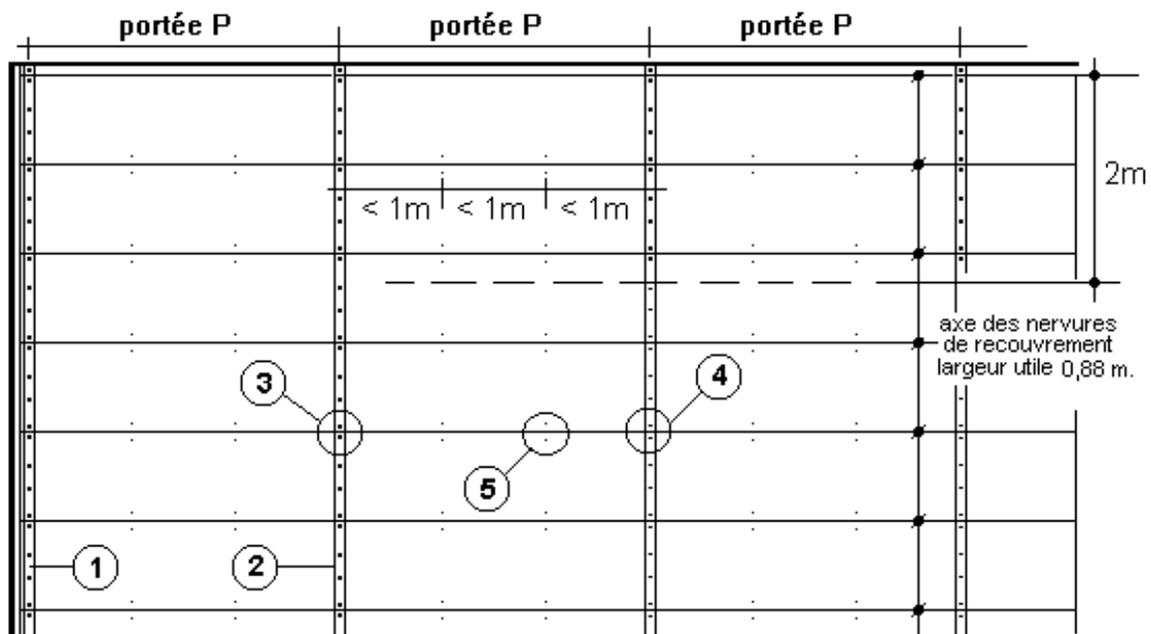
Fixations du bac PARASTEEL 42 sur la charpente
